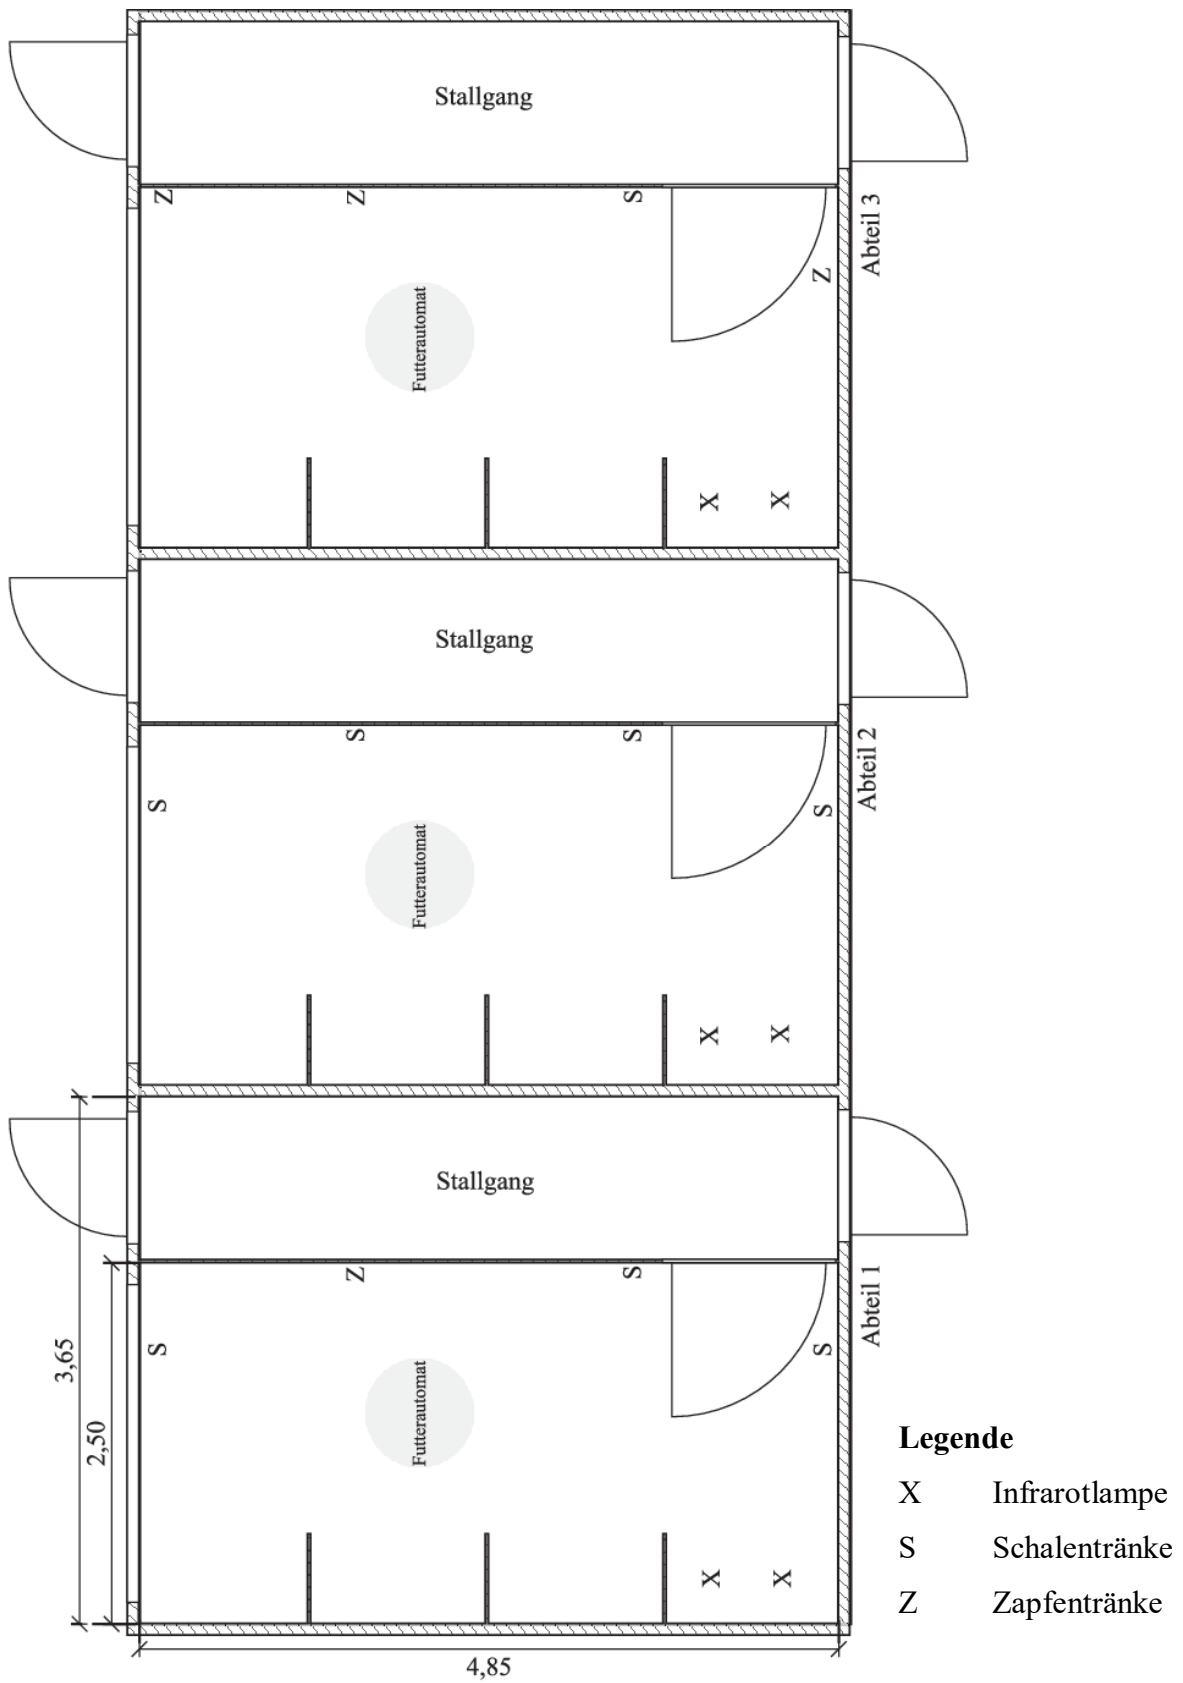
Grundriss der drei Stallabteile, Angaben in m
